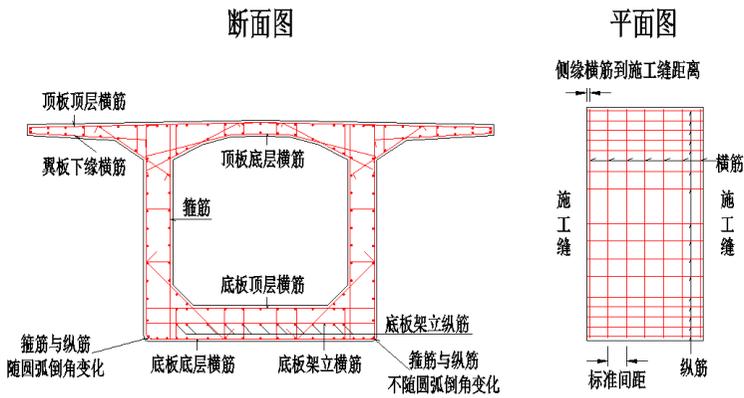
箱梁钢筋-横筋与箍筋示意图
